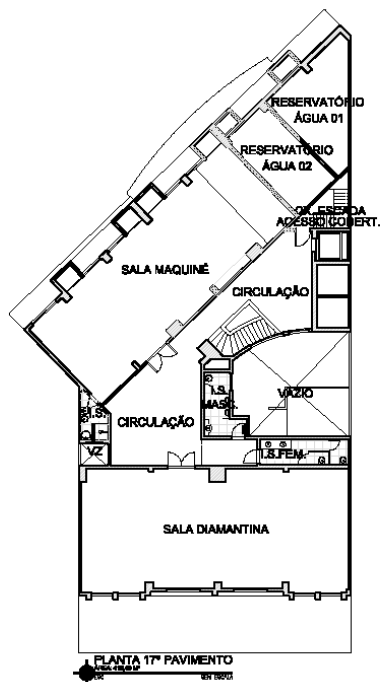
PLANTA 17º PAVIMENTO – ELABORADO PELA AUTORA – 09/2011.
